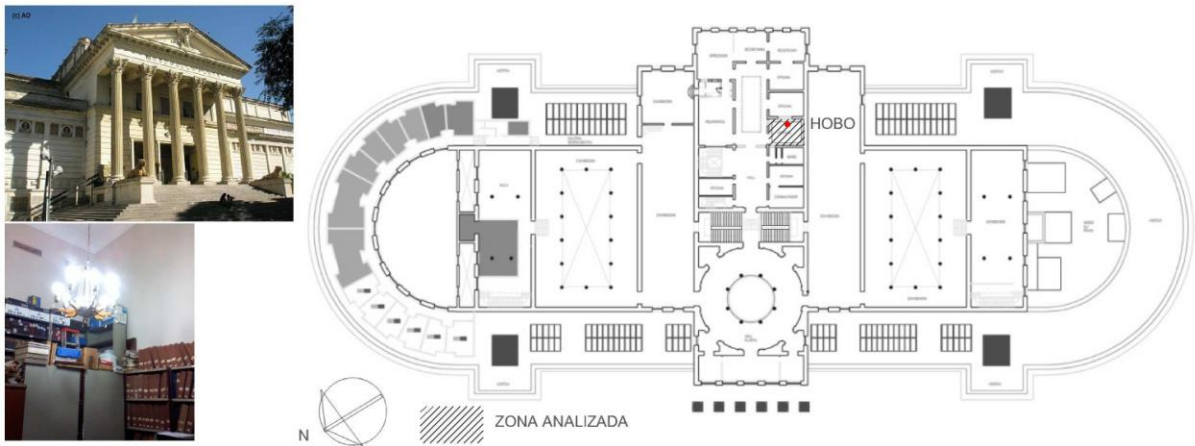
Planta, vista exterior e interior del Archivo Histórico y Fotográfico del Museo de La Plata.
